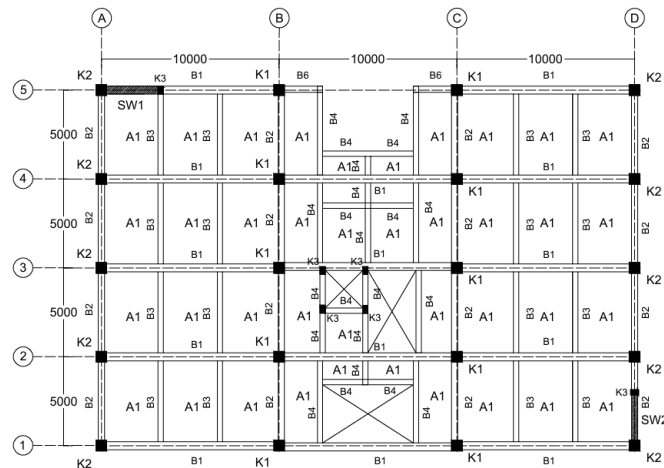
Denah lantai 5 gedung eksisting (model 1)
